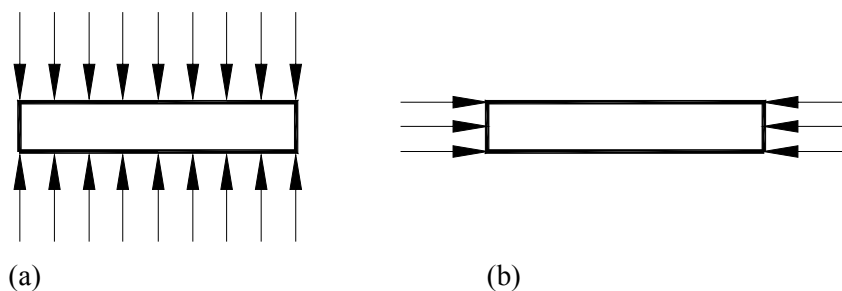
Ensayo de piezas de fábrica bajo compresión uniaxial perpendicular (a) y paralela (b) a la cara de unión.
